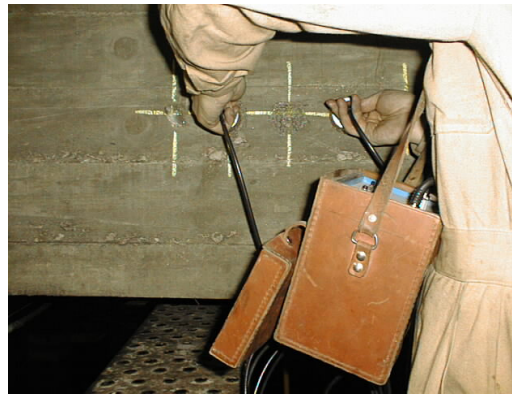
Execução do ensaio para determinação da profundidade de fissuras.
